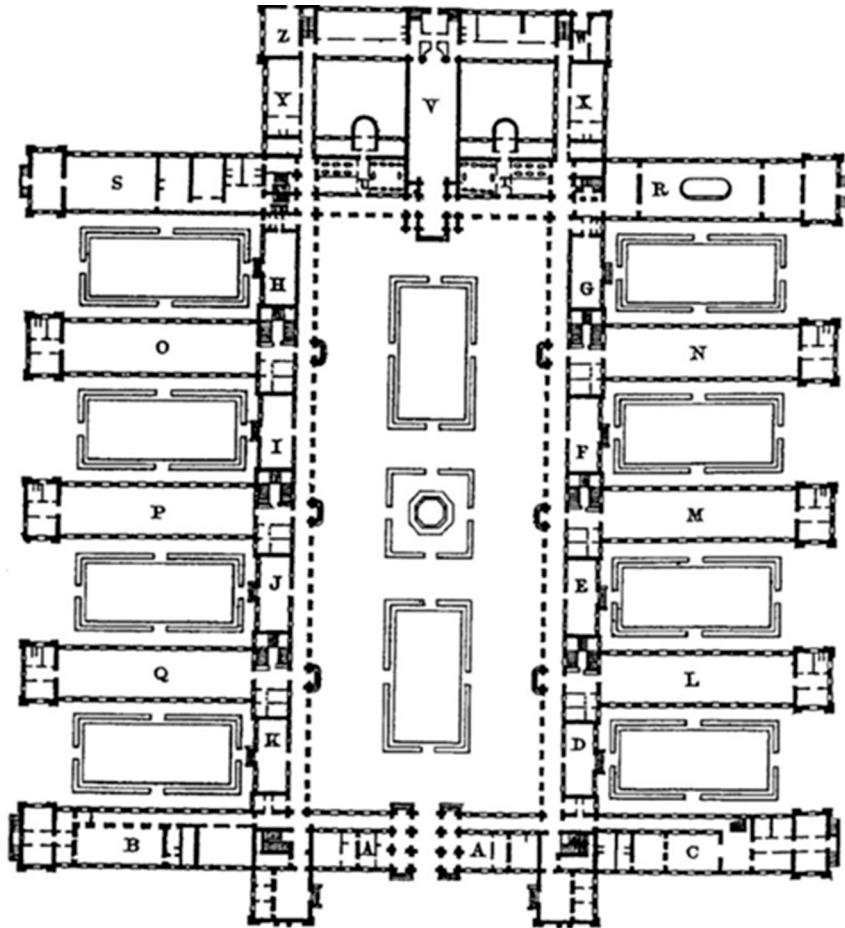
Hopital Lariboisiere*, Parigi. Planimetria dell'ospedale su progetto di M.P. Gauthier (1846-1854)
